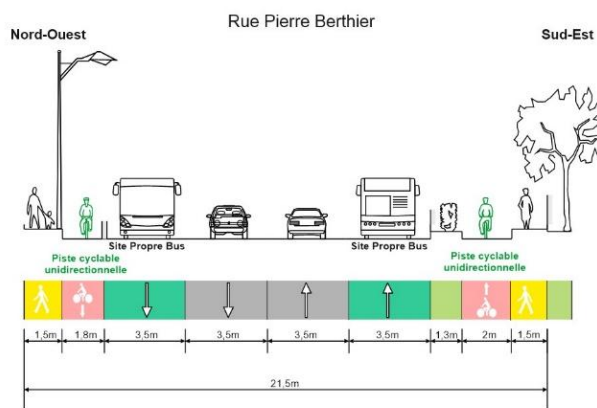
Profil en travers rue Pierre Berthier (section Est)
